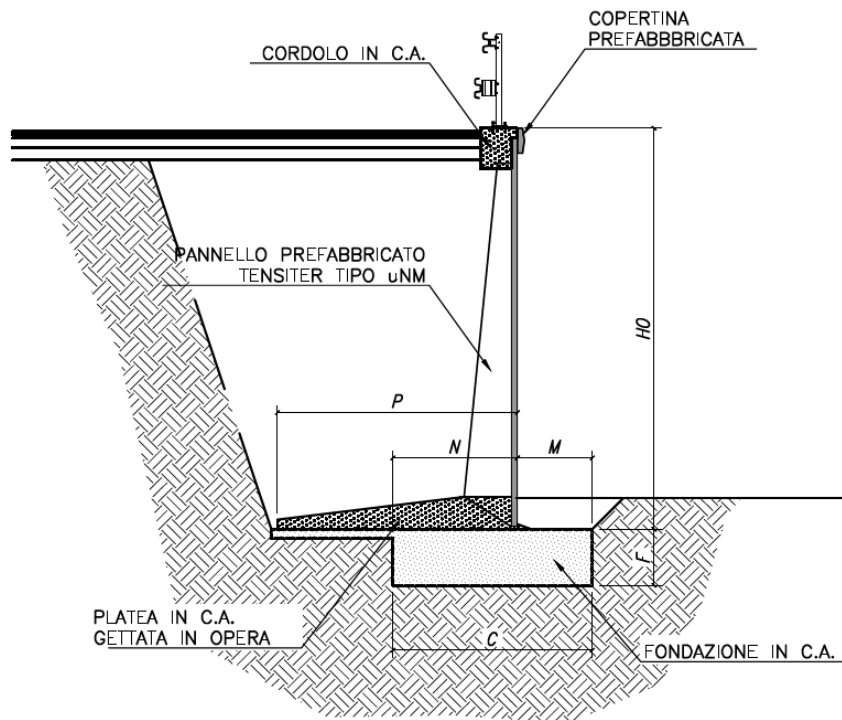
Sezione tipologica muro prefabbricato di tipo “uNM”
